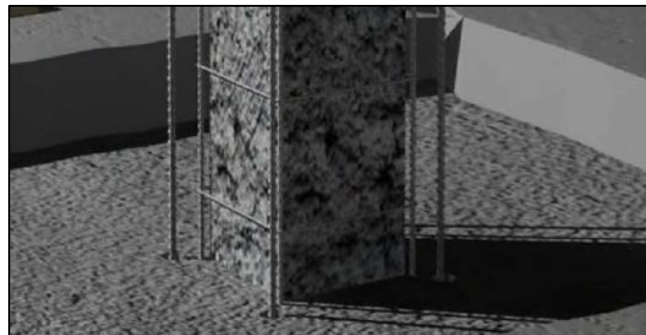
Refuerzo perimetral a columnas existente a realizar - 1
